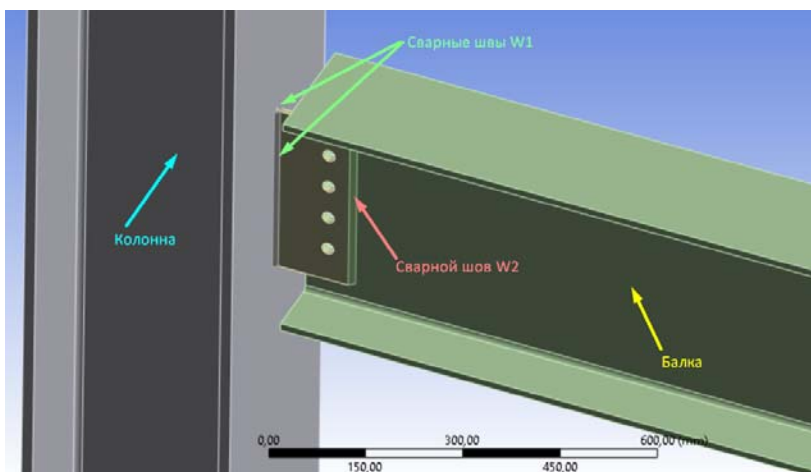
Модель гибкого сварного соединения в ПК Ansys
